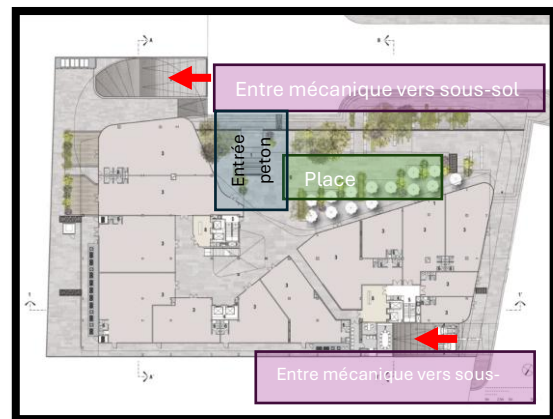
plan accessibilité ver rdc + sous-sol source : www.archdaily.com traite par les auteurs
